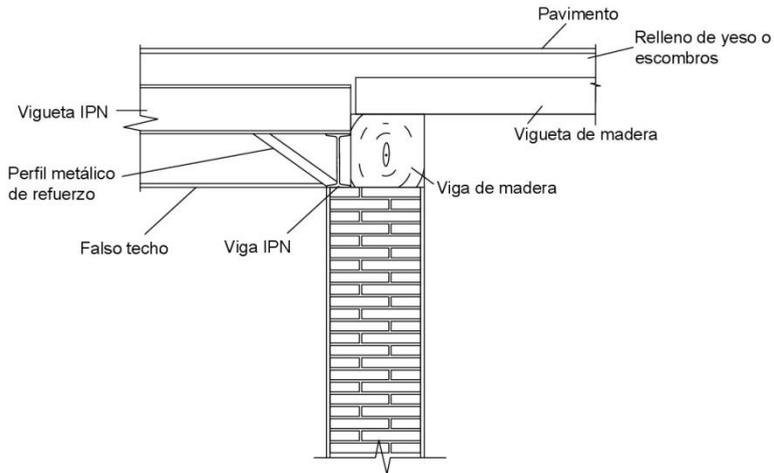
Detalle refuerzo mirador. 2018. Fuente: Propia
